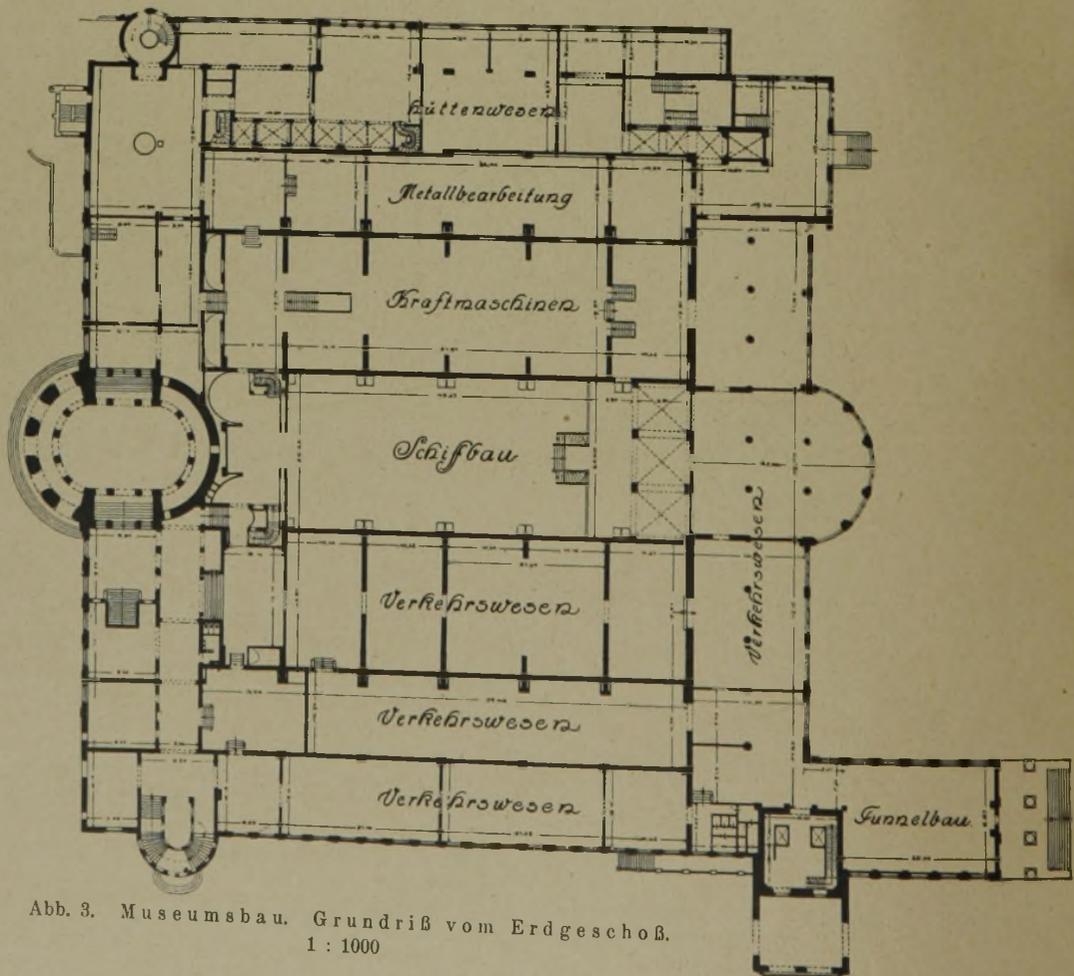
Museumsbau. Grundriß vom Erdgeschoß.
